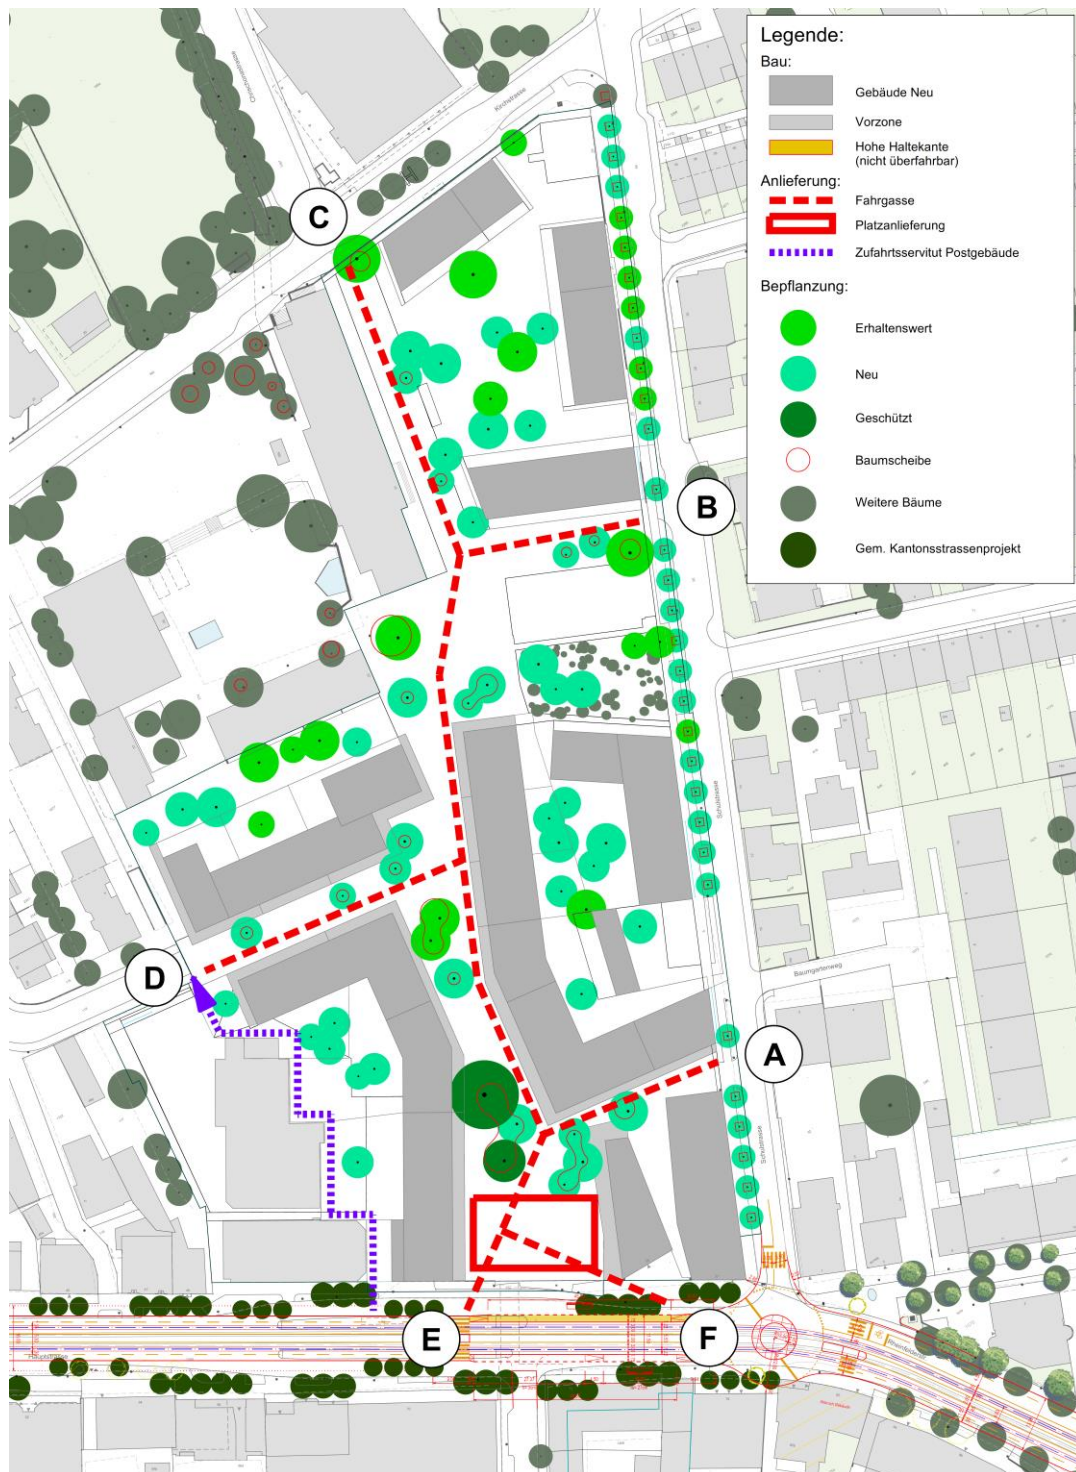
Situationsplan (QP-Plan und Kantonsstrassenprojekt) mit Fahrgassen Anlieferung
